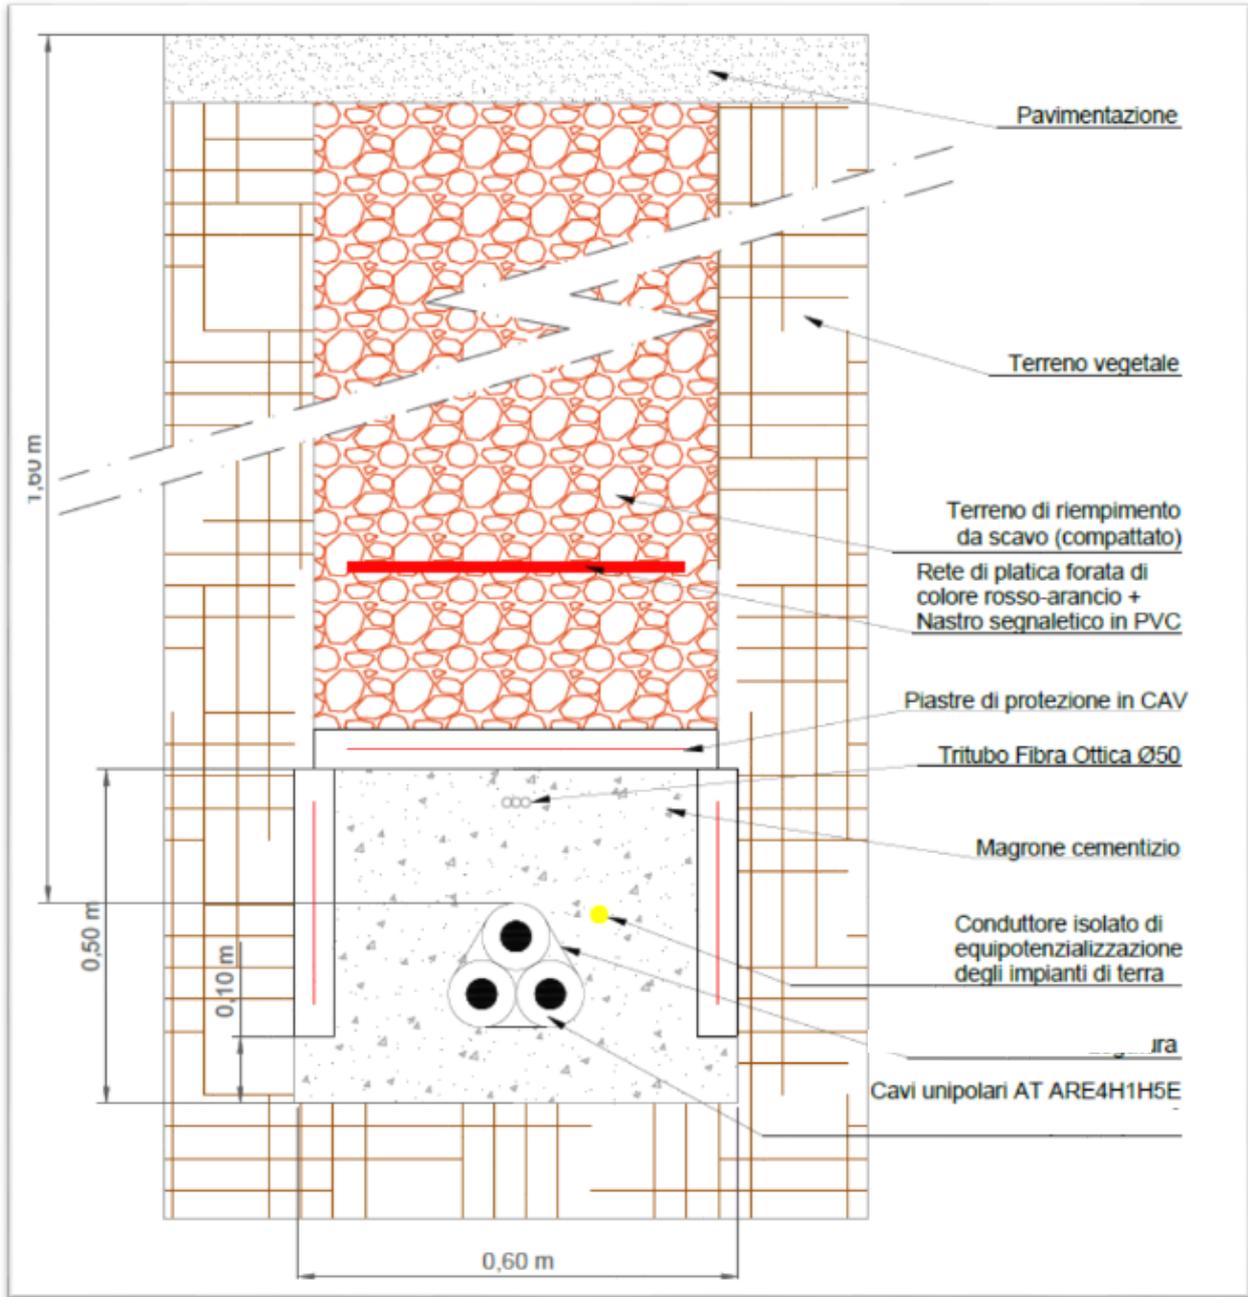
particolare di posa cavo AT 150 kV di collegamento con la futura Stazione Elettrica di Trasformazione
